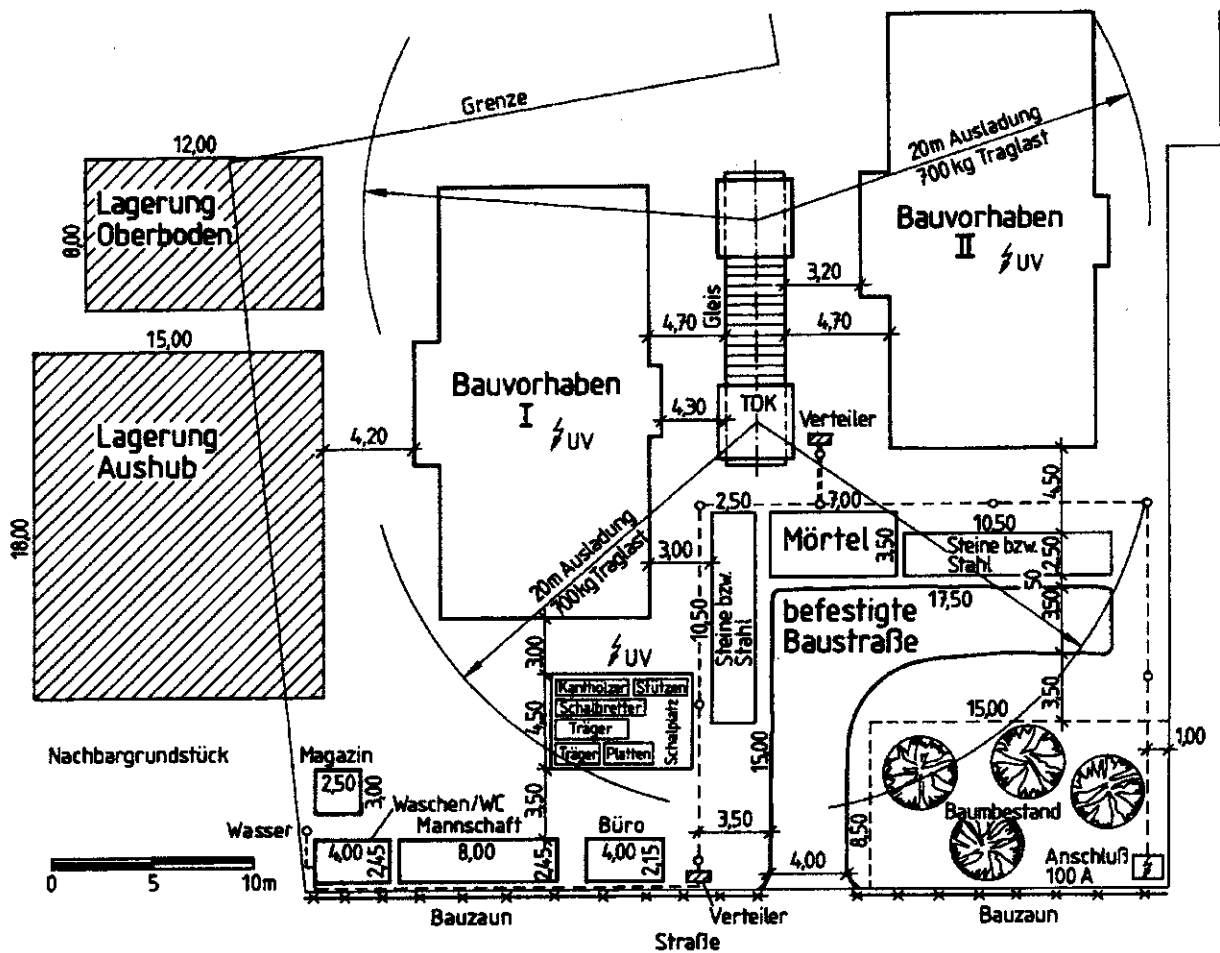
Baustelleneinrichtungsplan [Hoffmann/Kremer, 1992 -384-]
